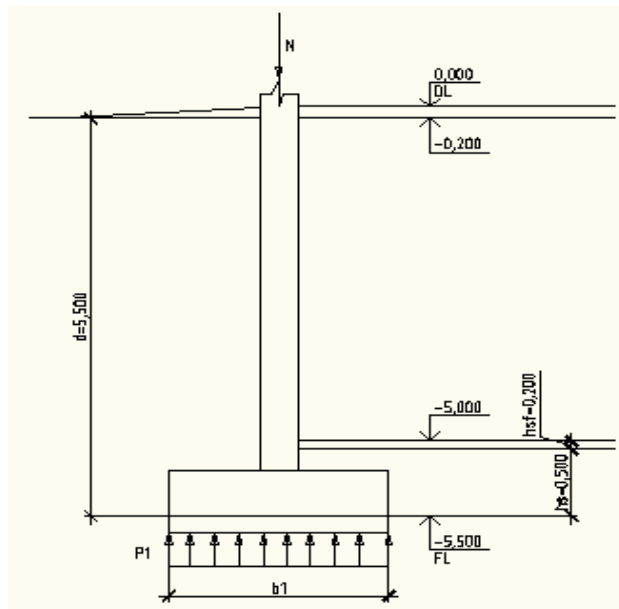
Схема к определению размеров подошвы фундамента
